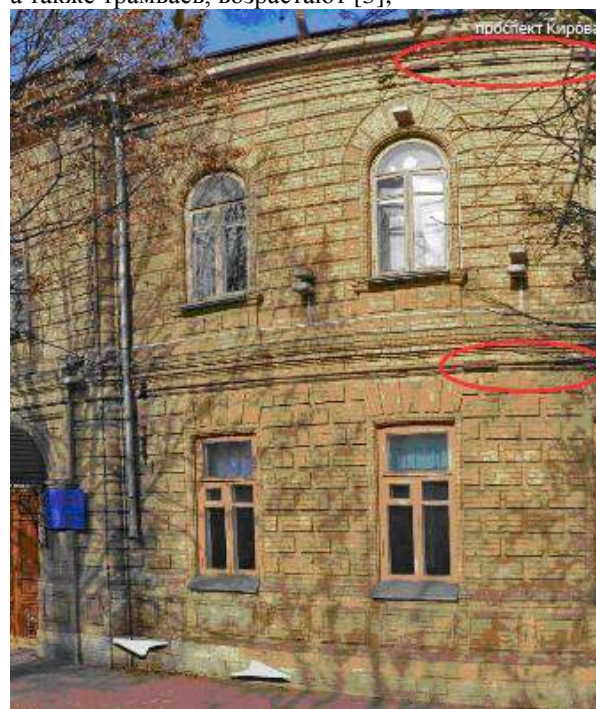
Фасад здания с поэтажным усилением металлическими тяжами (в уровне перекрытий)
